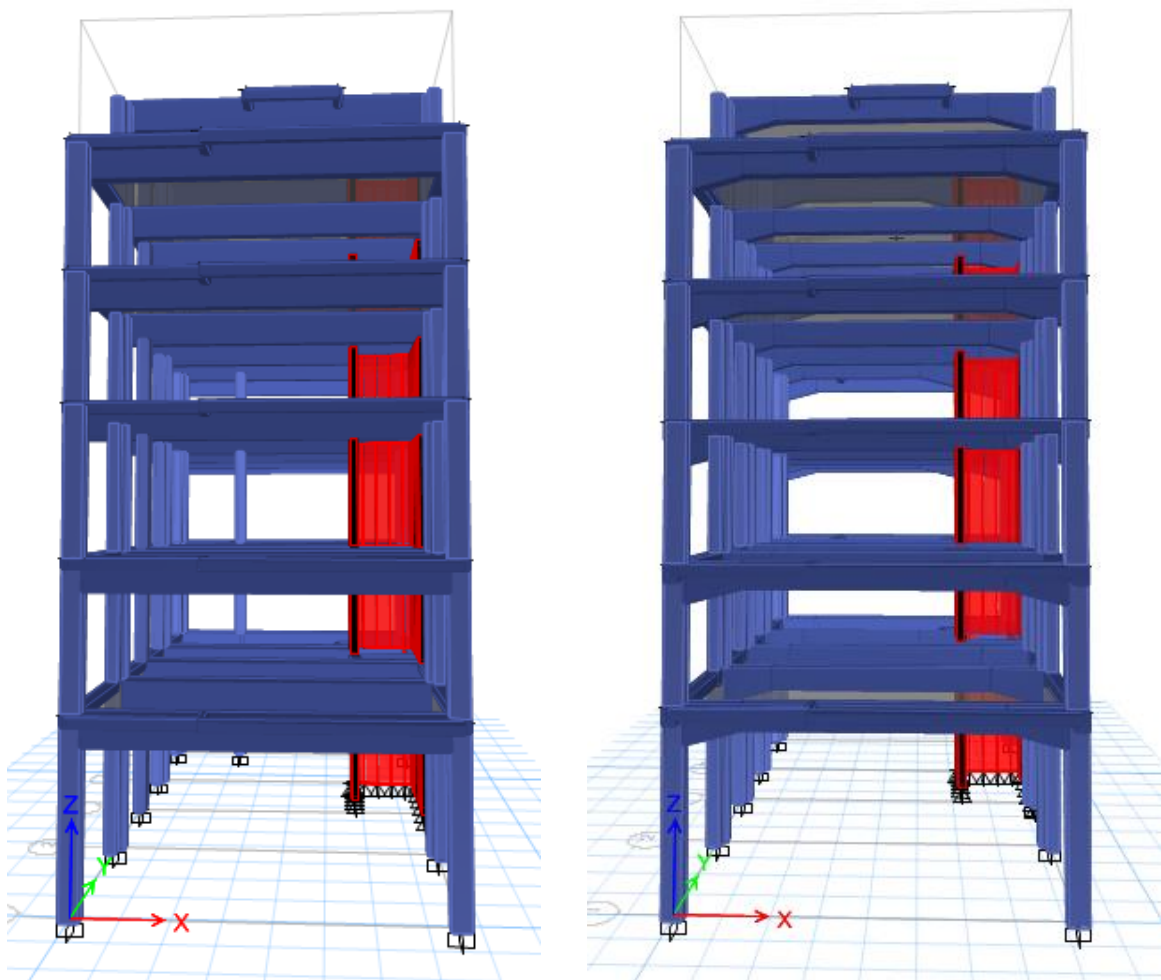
34 Vista frontal de Vigas de Sección Constante y Vigas de Sección Variable.
